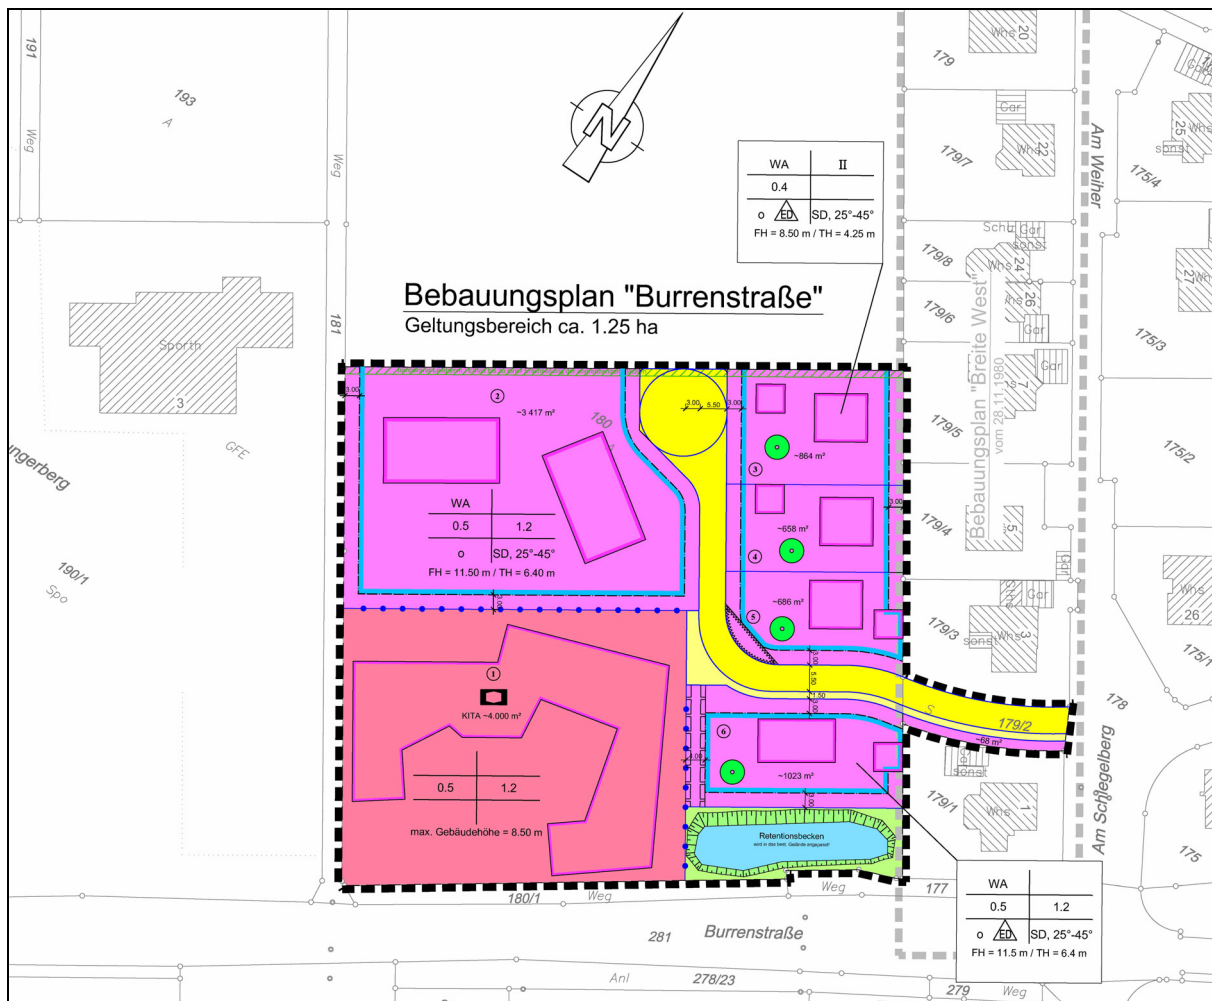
Bebauungsplan „Burrenstraße“ Variante 1 (ES tiefbauplanung)
